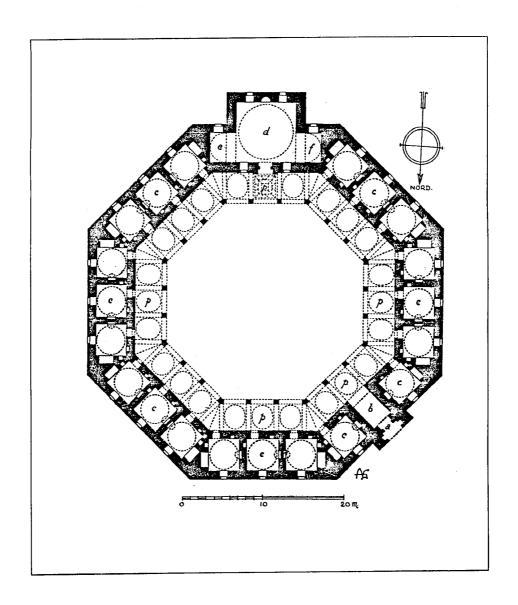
مسقط أفقي لمدرسة الصدر الأعظم قوچه سنان باشا في استانبول (عن : عبد الحافظ) .
